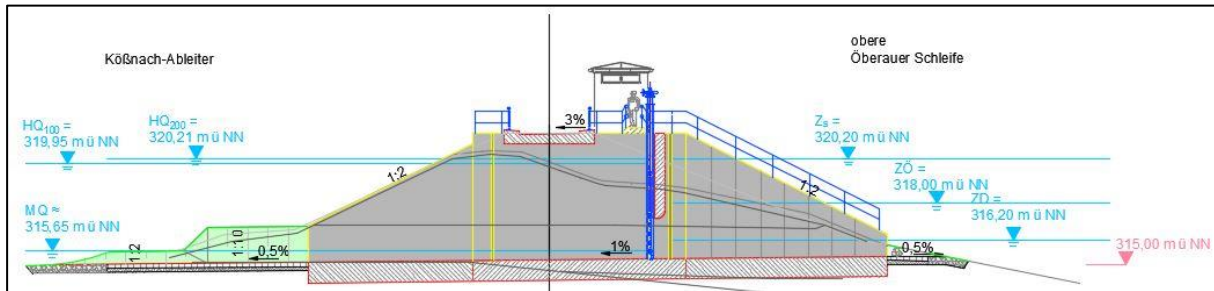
teiloffene Bauweise mit Staubalken und Brücke
